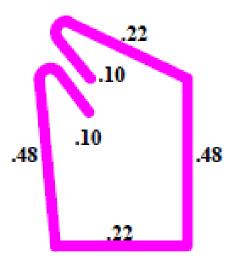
Despieces de estribos iniciales para las vigas de cimentación. Fuente: Planos estructurales.
